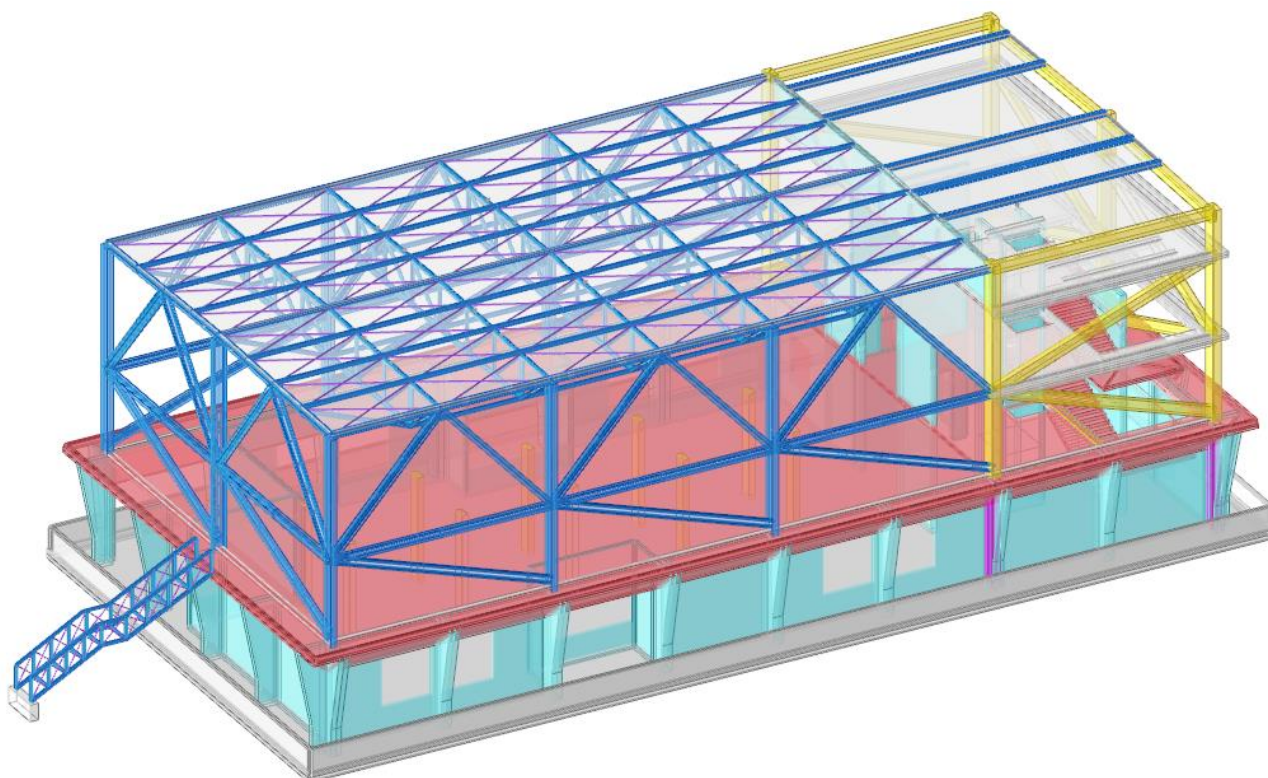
Vista 3D del Modello Strutturale FEM – Corpo A – Vista Assonometrica – Stato di Progetto
